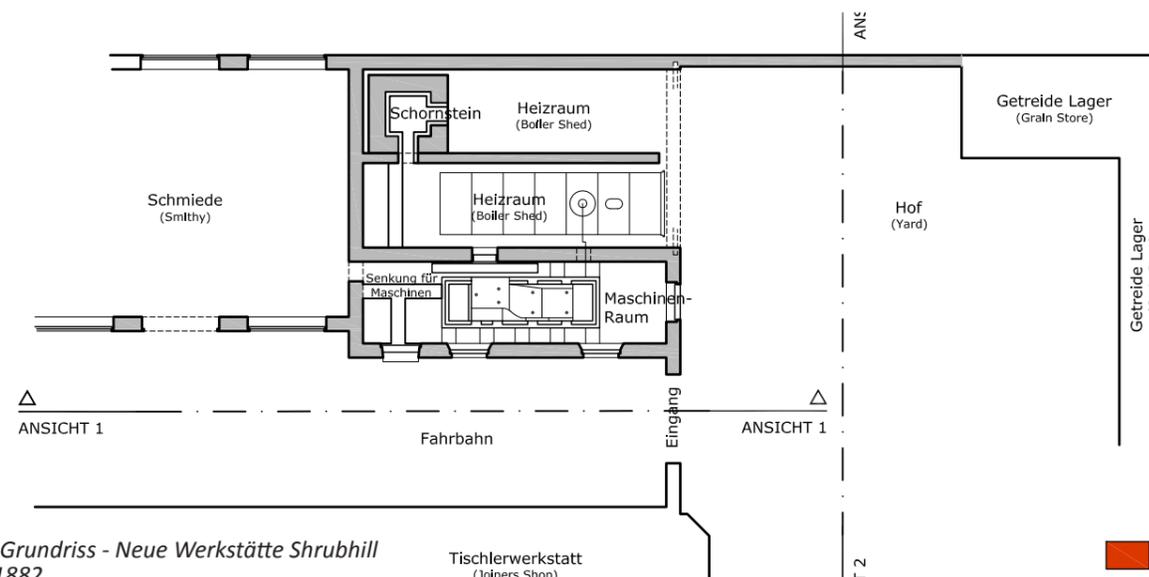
Grundriss - Neue Werkstätte Shrubhill
